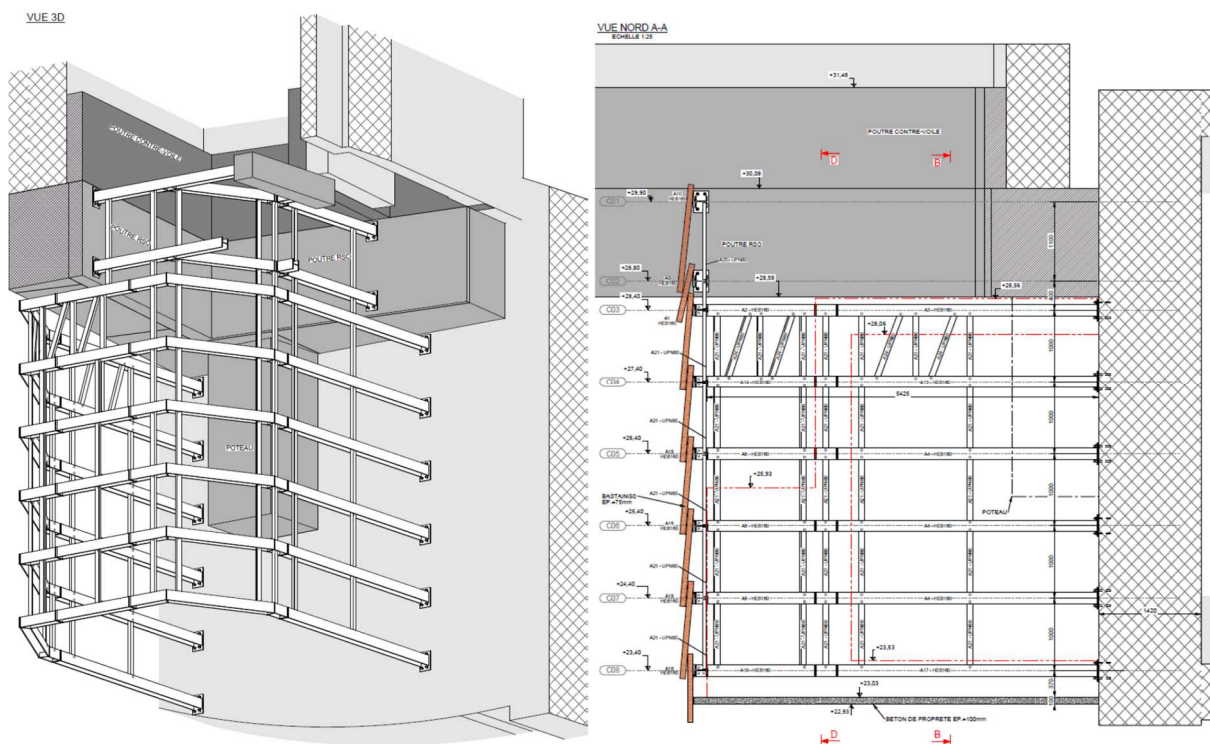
Vue 3D et coupe du système de poutres et du soutènement provisoires par cintres
